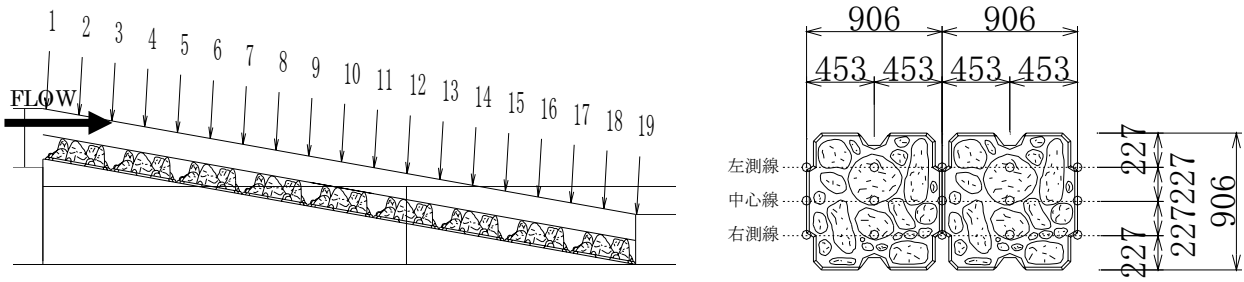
縦断水面形の測定位置 (左：概略縦断面図 右：計測位置平面詳細図 引出寸法の単位：mm)
